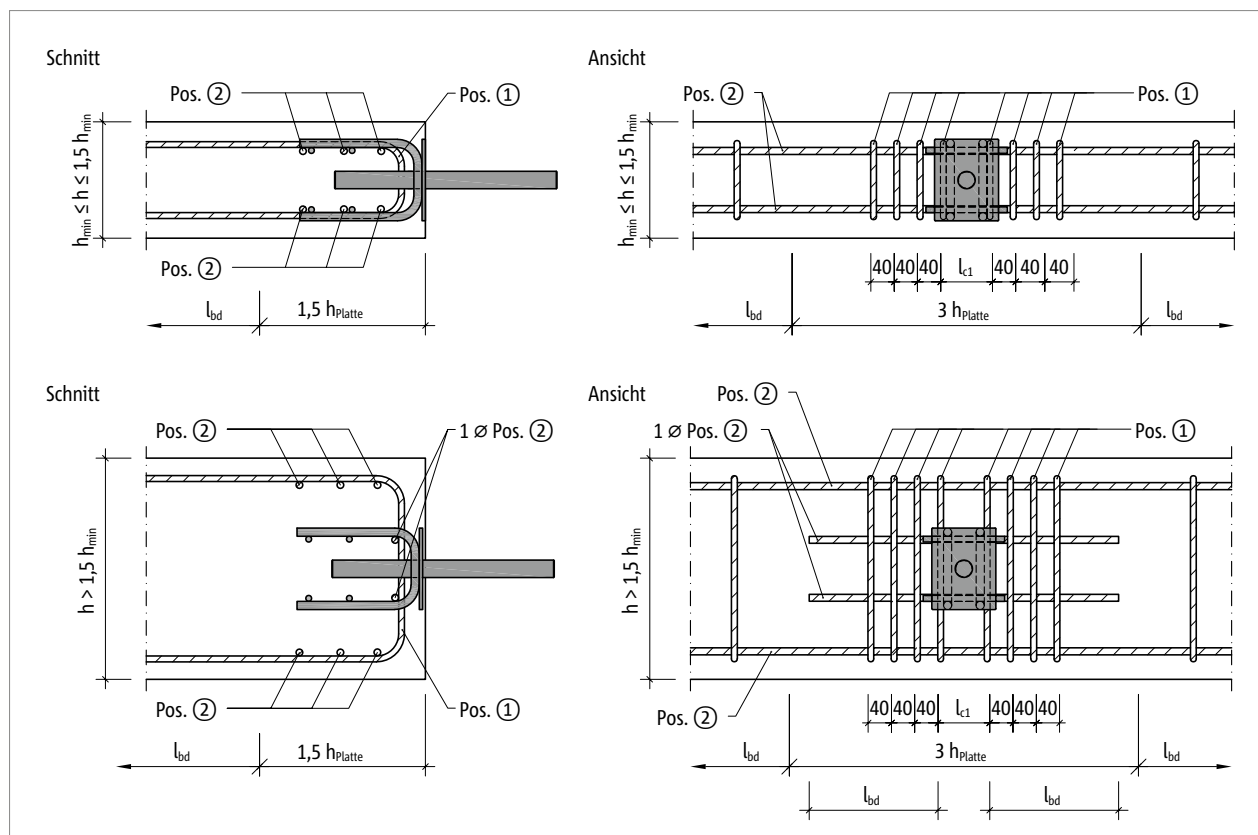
Bauseitige Bewehrung Stacon®SLD
